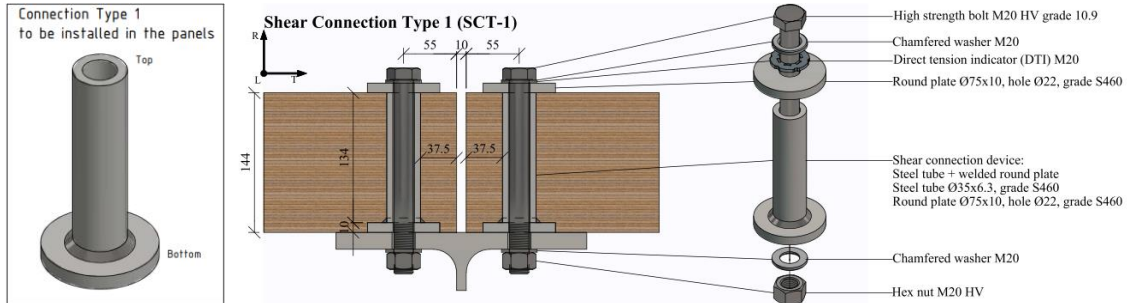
Conectores de rasante del forjado mixto acero-madera [65]
